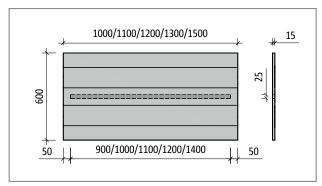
Schöck Tronsole® tipo B-V1-L...-B600, pianta del prodotto
